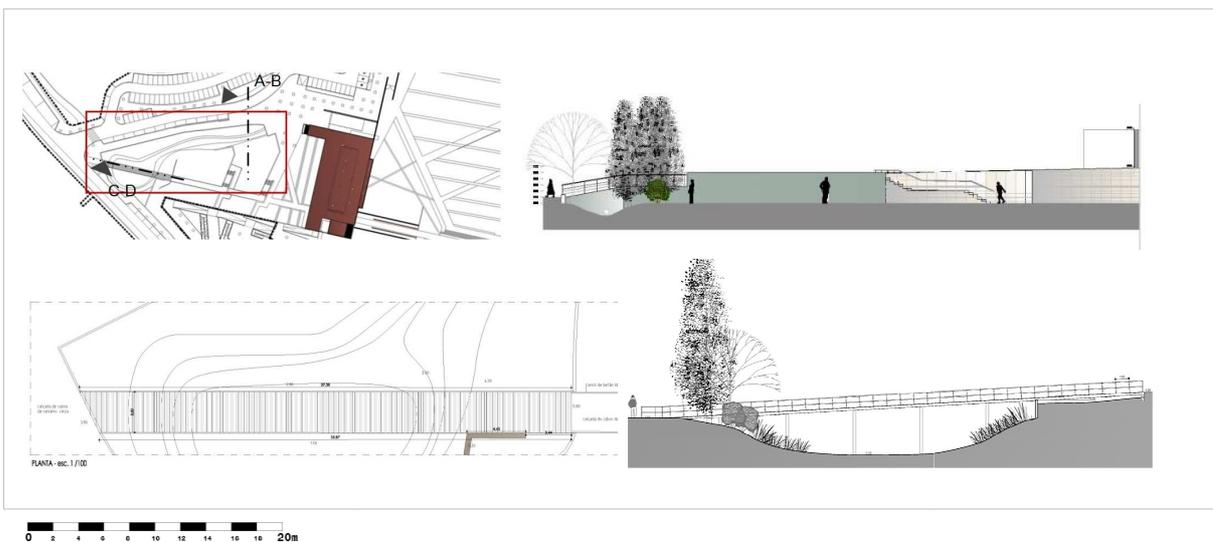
À esquerda, em cima: planta com localização da linha de drenagem (bacia de retenção); em baixo: planta do passadiço; à direita, em cima: corte A-B (corte transversal do sector montante da linha de drenagem) (S/Esc.), em baixo: corte C-D (S/Esc.).
